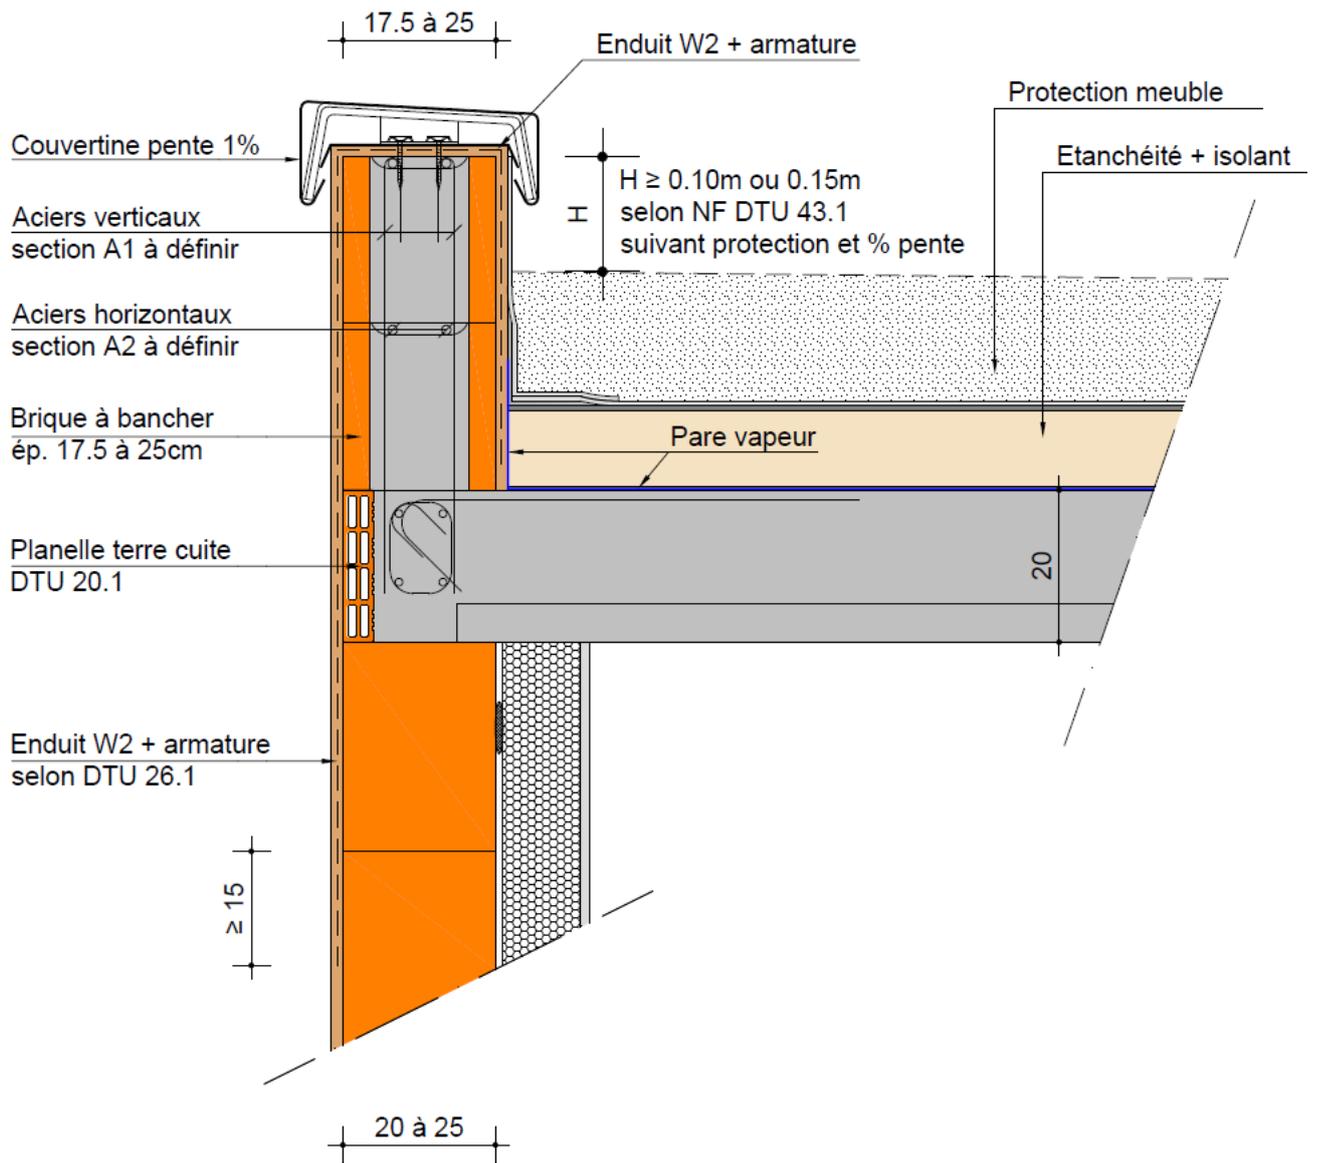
Coupe avec acrotère bas, terrasse non accessible (2)
